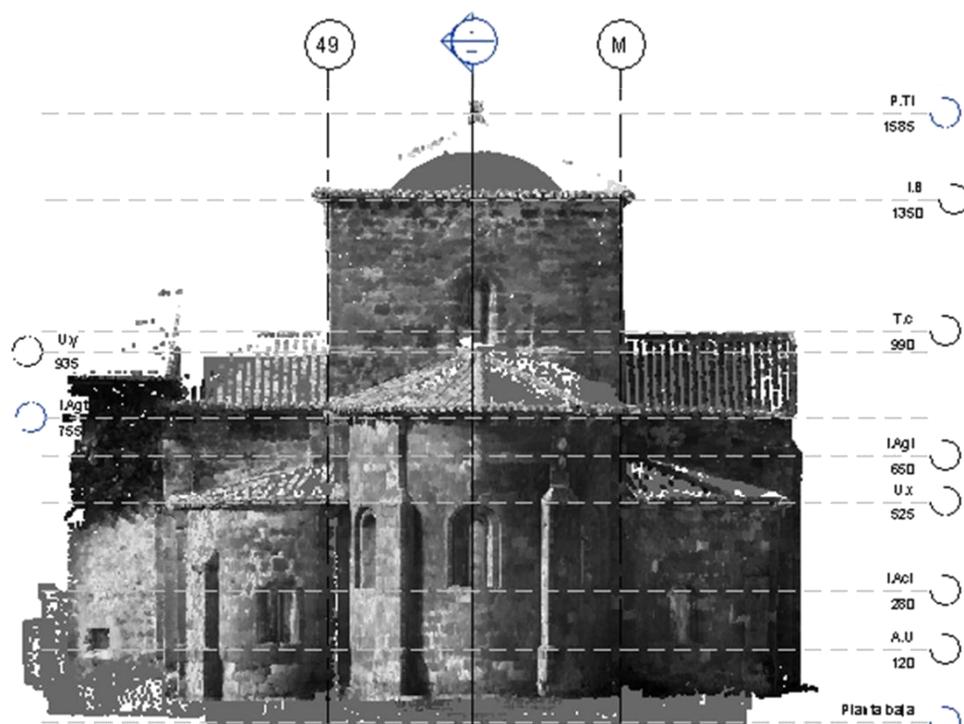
Elevación oeste de la nube de puntos delimitada con la herramienta grilla.
